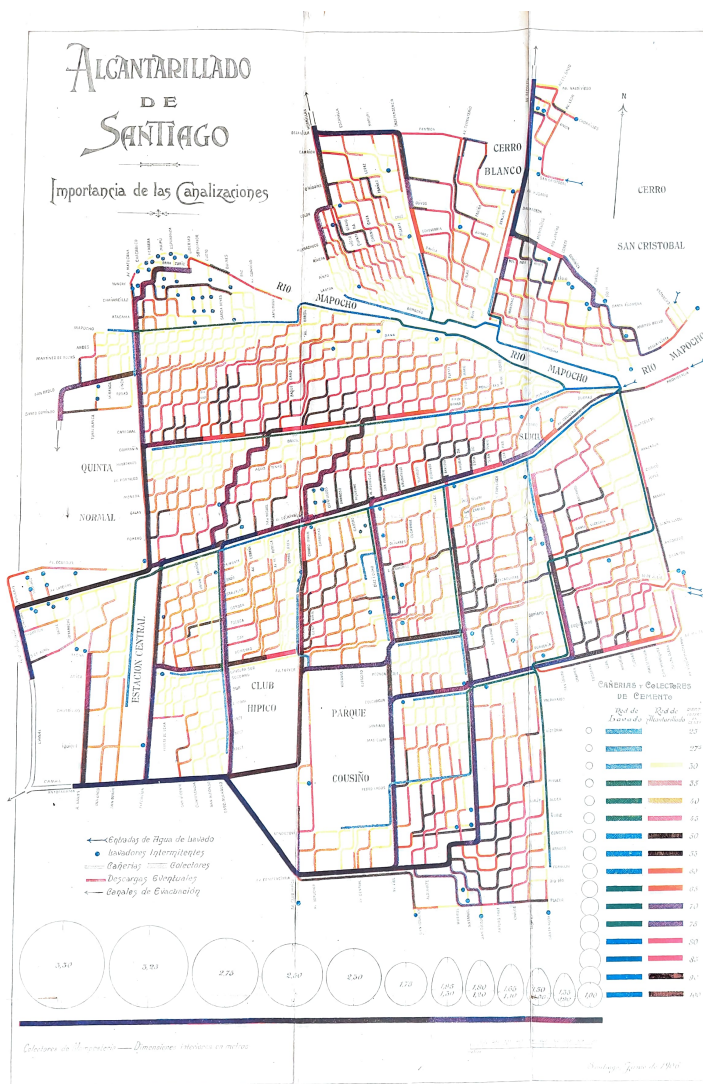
Plan para el inicio de alcantarillado de Santiago, junio 1906
